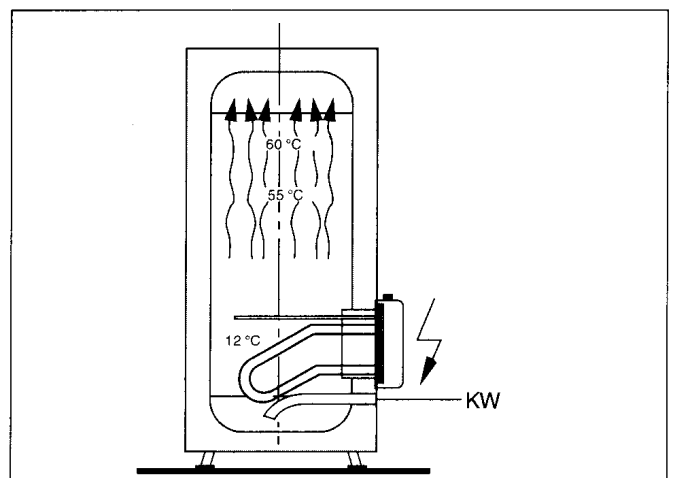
Situation bei Tagesnachladung mit unterem Heizelement
